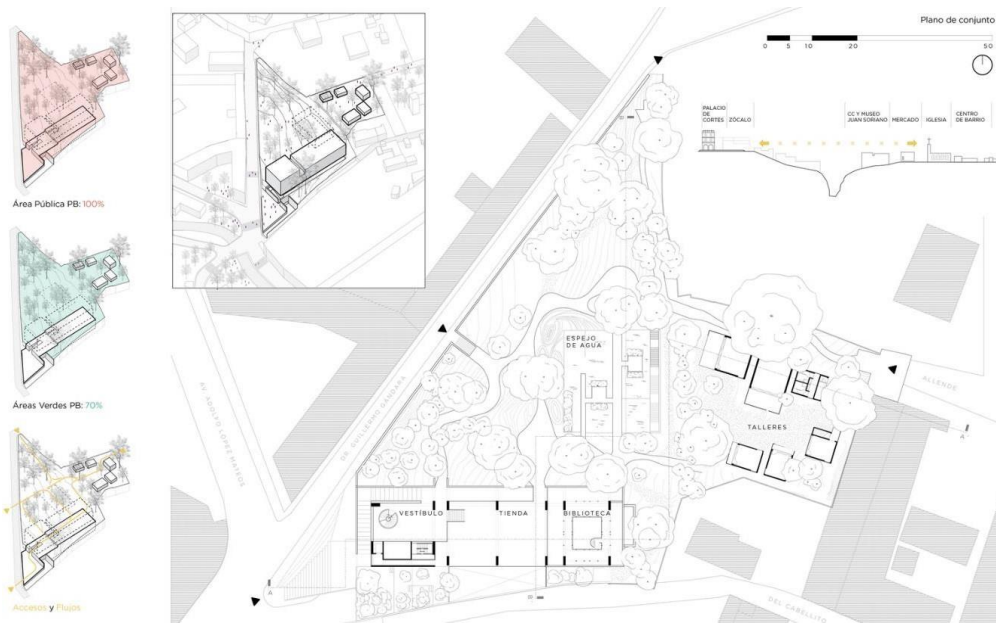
planta general del Centro cultural y Museo Juan Soriano
